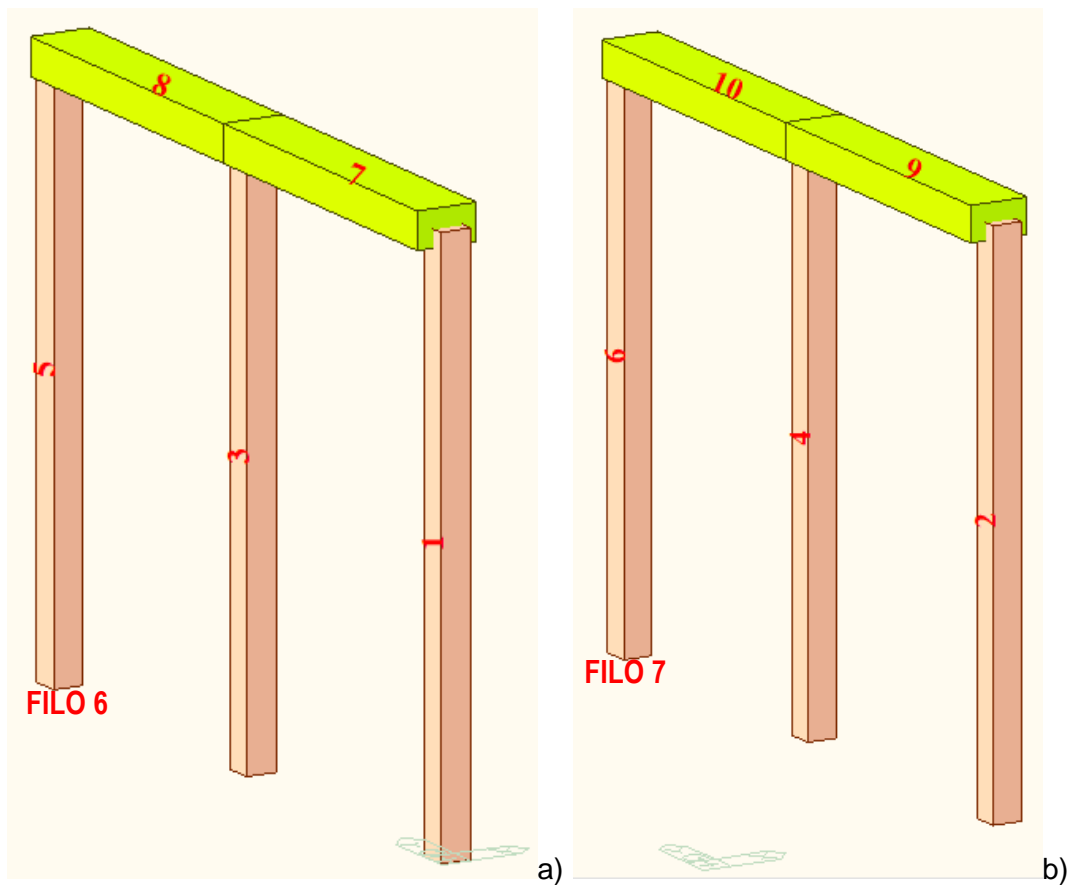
a) telaio filo 6 (collegamento A1-A2); b) telaio filo 7 (collegamento A1-A2)
